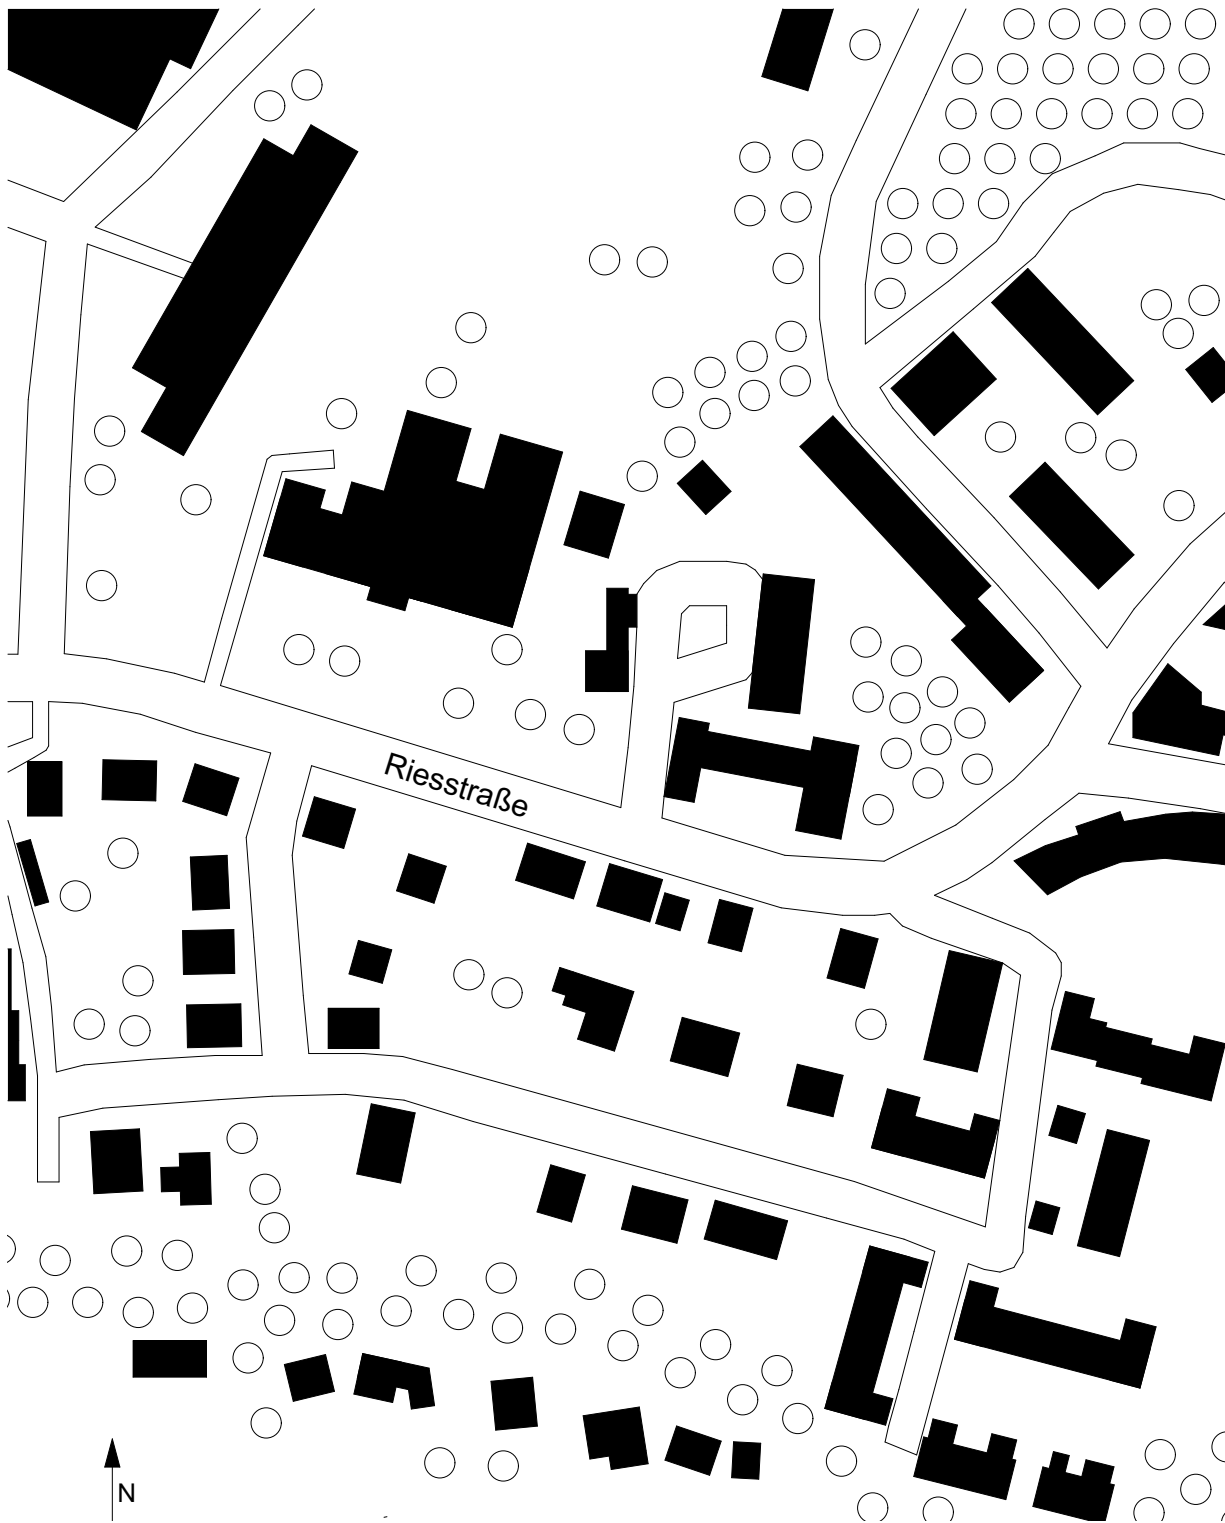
Lageplan Situation nach dem Bau - M 1:2000
